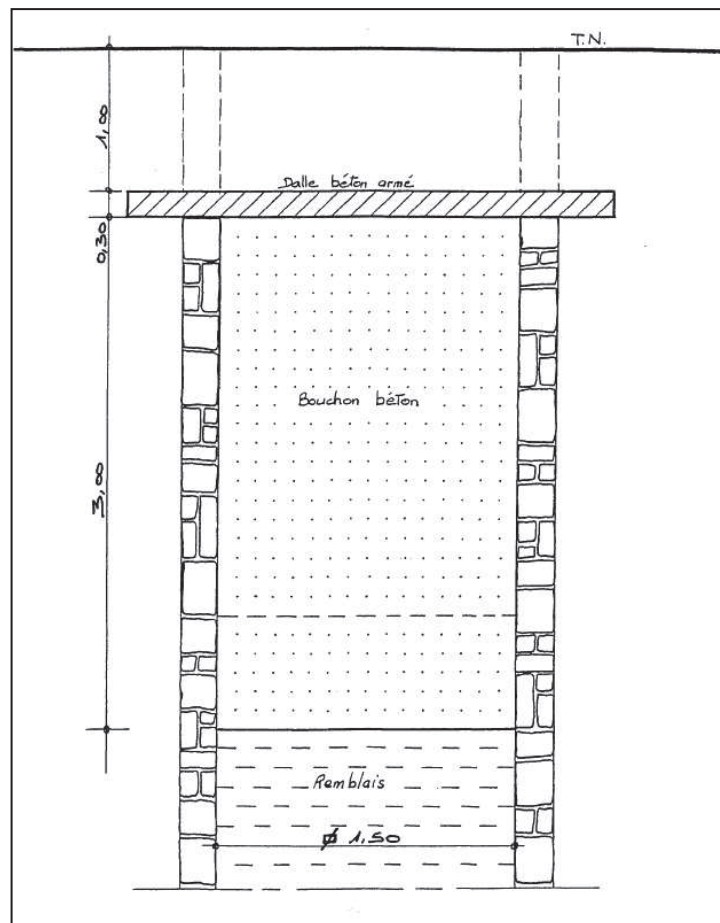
Schéma de mise en place du bouchon béton au puits de La Cloche
